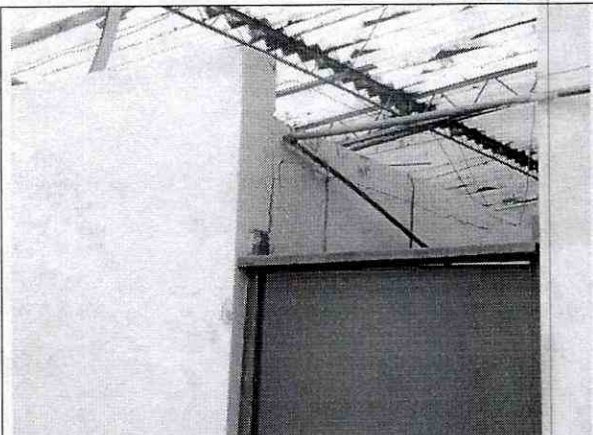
Agrietamiento horizontal que marca la separación entre placa y muros.
